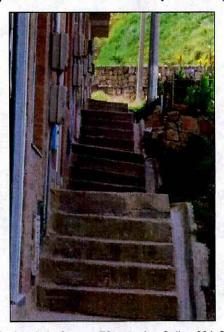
Detalle del hundimiento en el patio de la casa ubicada en la Cra. 72 # 68A-22 Sur
